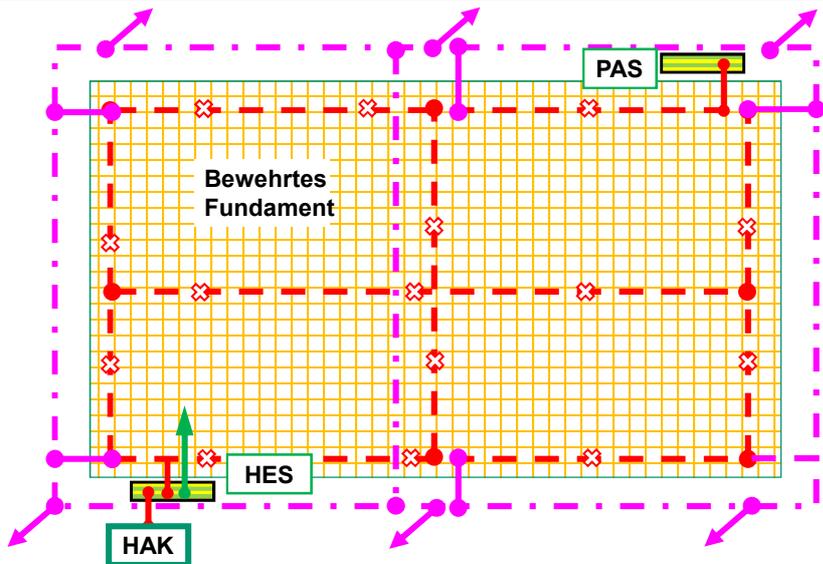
Prinzipdarstellung für eine Erdungsanlage mit Ringerder bei einem Fundament mit erhöhtem Erdübergangswiderstand - Draufsicht
